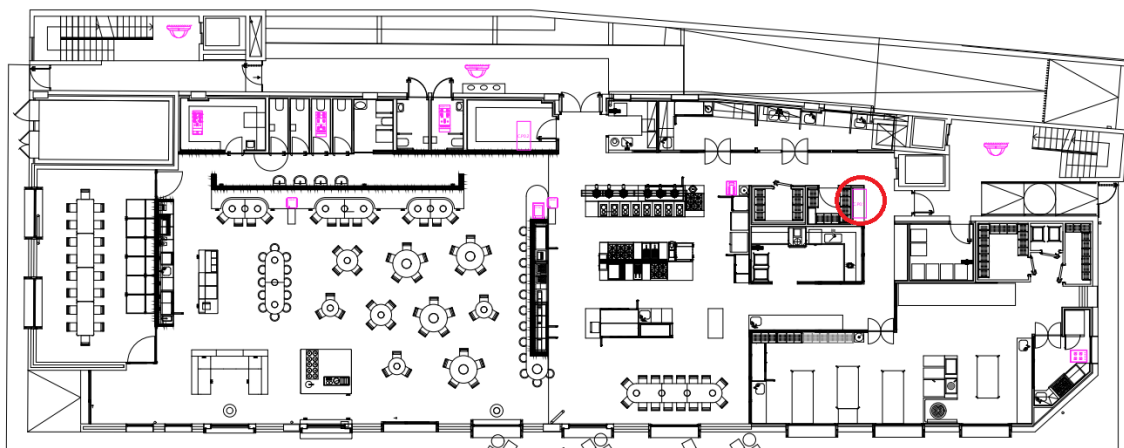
Ubicación cuadro 1 de la planta baja (C.P0.1).
